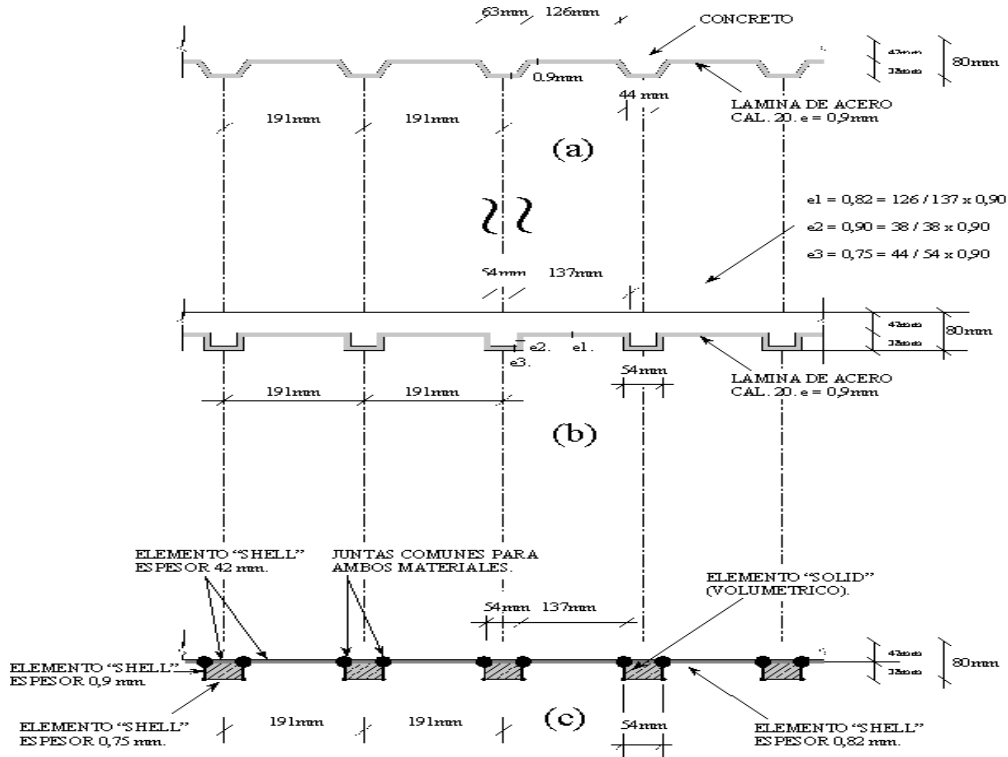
Losa compuesta: a) Sección transversal; b) Sección transversal simplificada; c) Modelo constituido por elementos finitos tipo "shell" (plano) y tipo "solid" (volumétrico)
